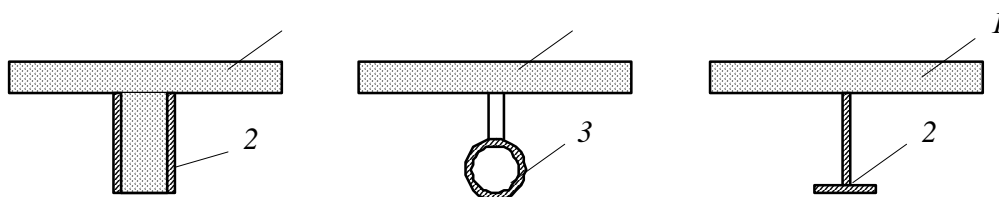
Поперечний переріз сталезалізобетонних балок:
